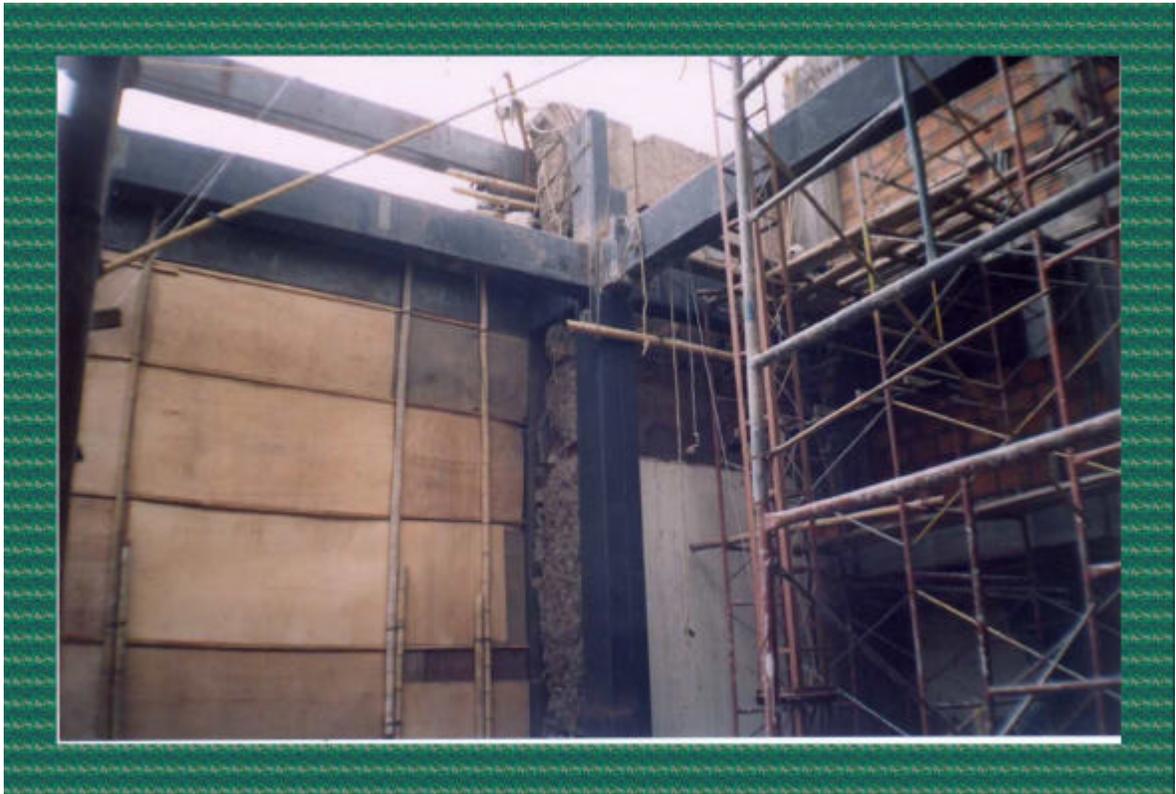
Montaje de dos vigas al nivel 14.42m, donde una de ellas tiene platina doble y es pernada
